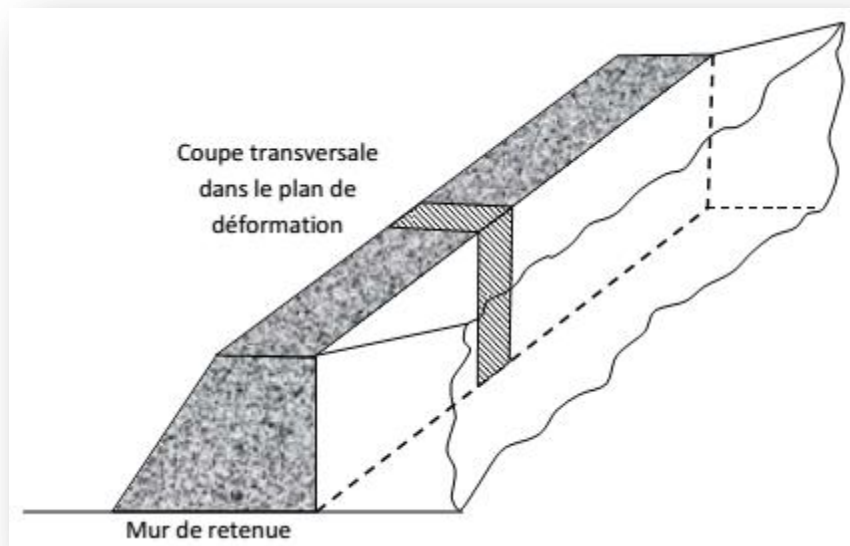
Exemple d’un cas de déformations planes (une coupe transversale du mur de barrage)
